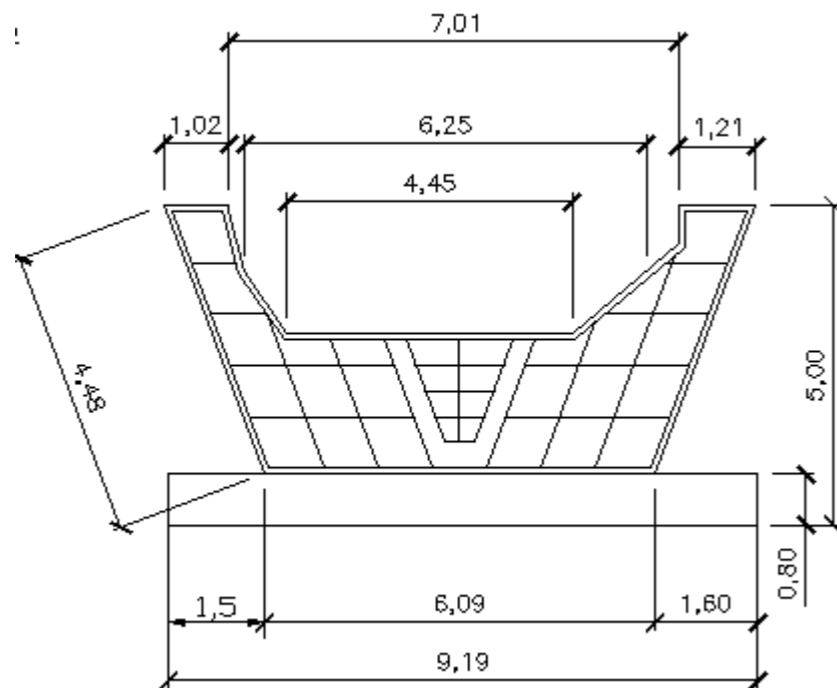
Diseño final del estribo sin el tablero (alzado). Fuente: Elaboración propia.
